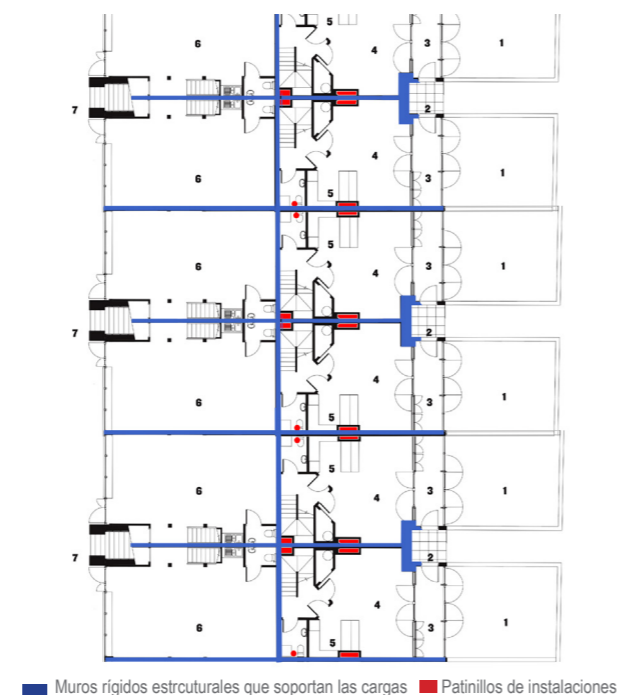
Esquema elementos fijos. Imagen con intervención propia
